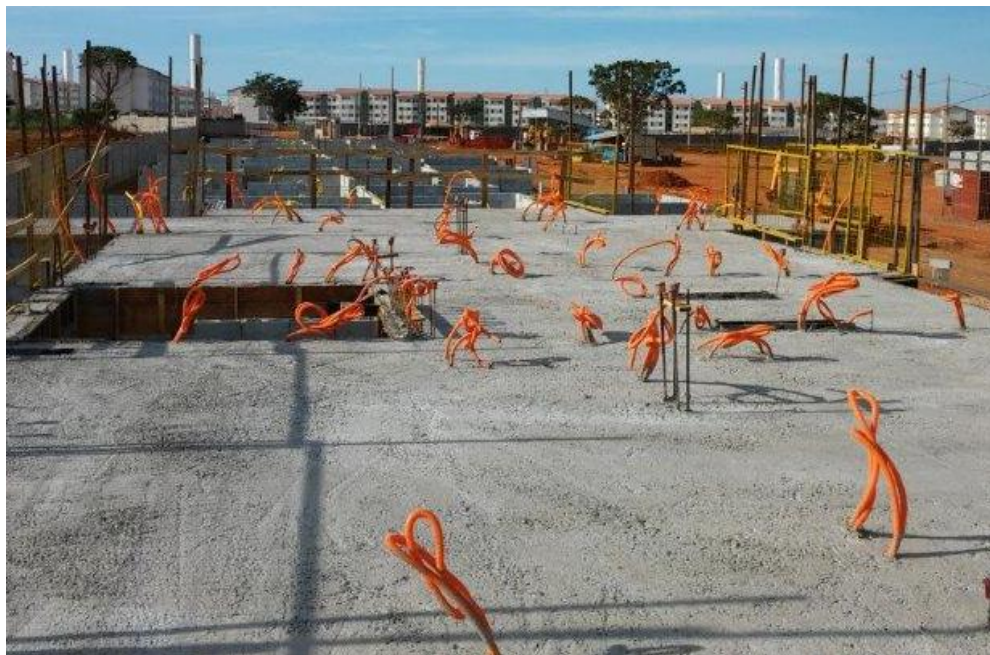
Vista da laje concretada: Fonte (do autor)
